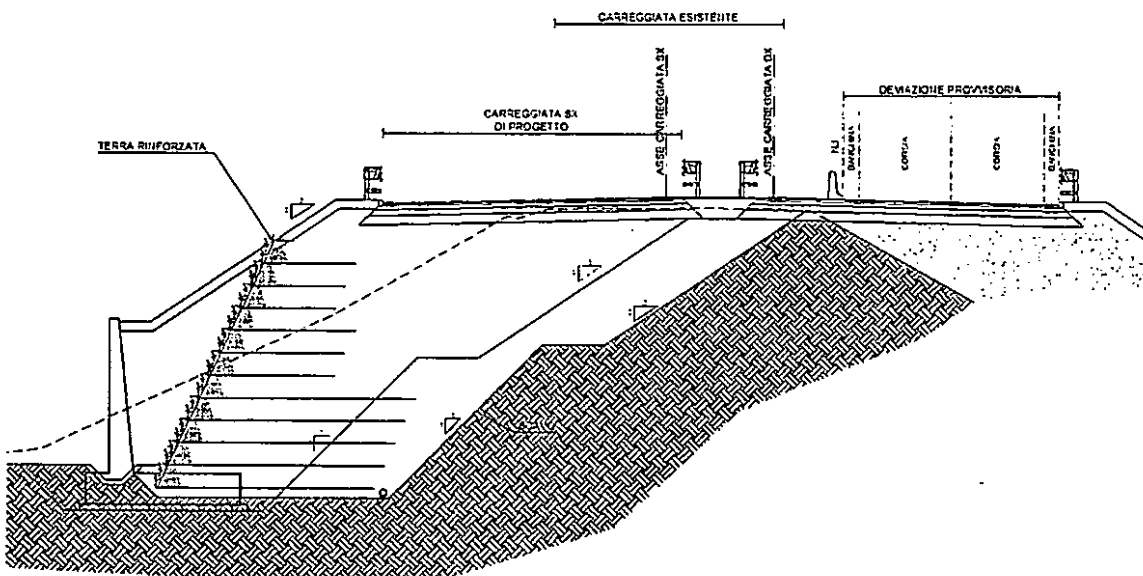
sezione di confronto tra muro in terra rinforzata e muro in c.a.
